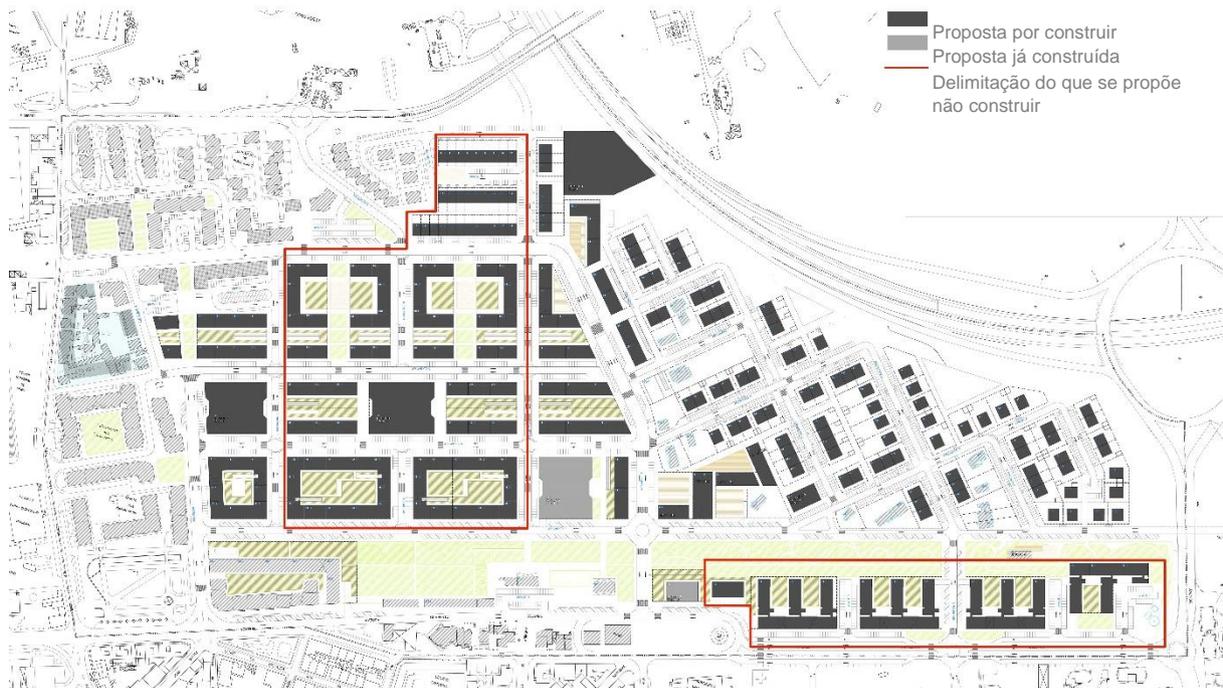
Plano de pormenor zona norte da cidade de Sines
